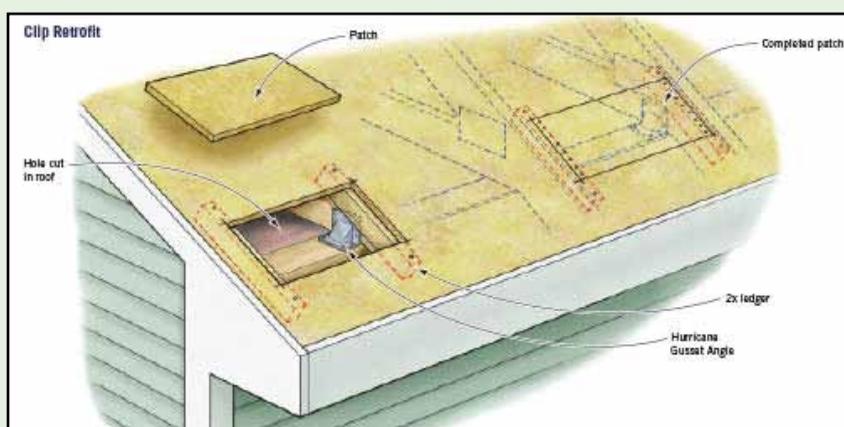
Para instalar conectores con la menor demolición posible, recorte orificios rectangulares entre pares de armaduras. Se puede sujetar un conector a la armadura de cada lado del orificio, permitiendo unir cuatro armaduras con solo dos orificios. Los agujeros se enmiendan apoyando el área sobre refuerzos clavados a los costados de las armaduras.
